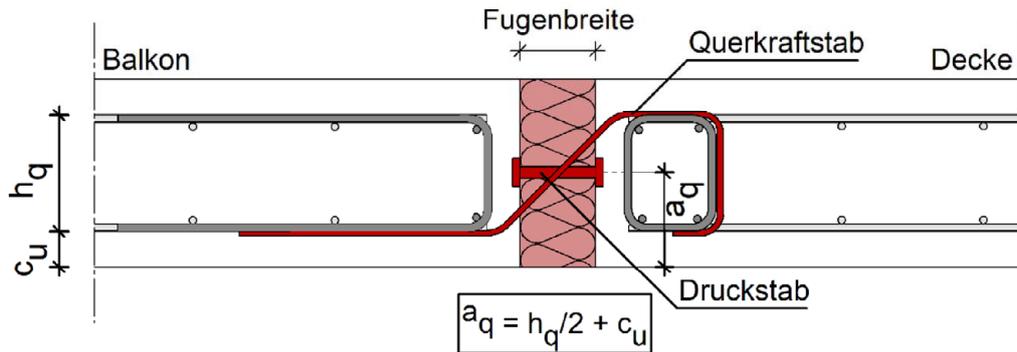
Egccobox Typ V – Querkraftanschluss – mittiges Drucklager und bauseitigem Randbalken
